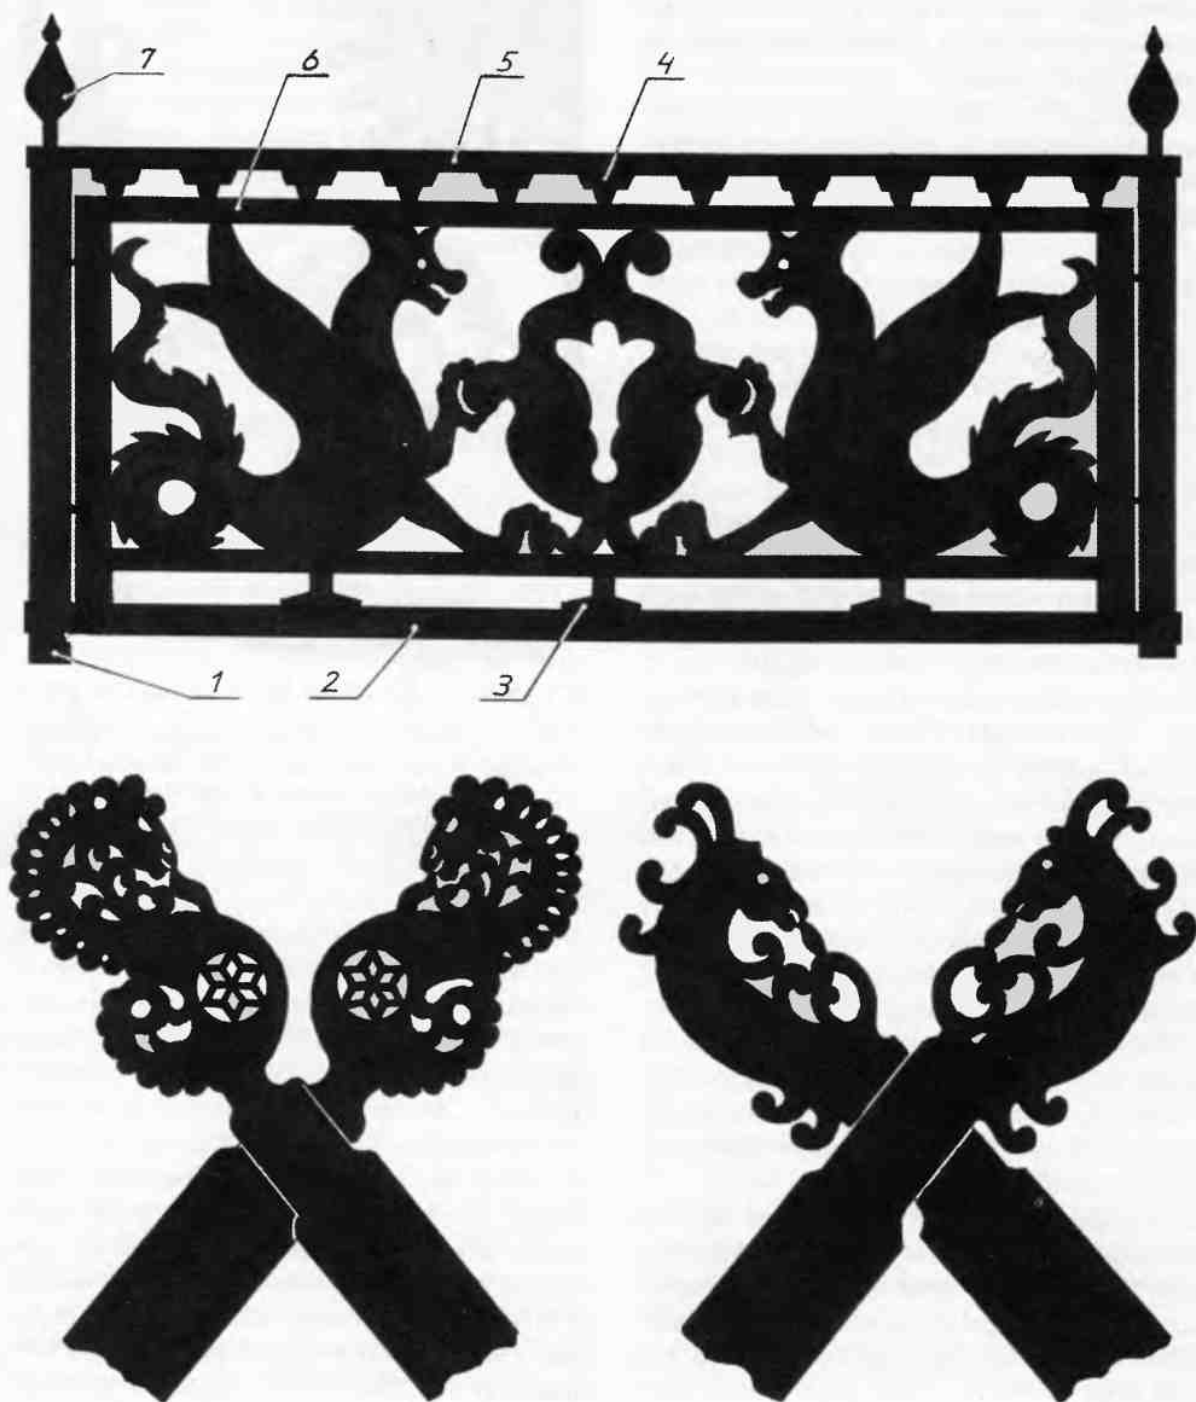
Дополнительные детали для декора крыши. Сверху — секция гребня крыши или декоративной ограды по краю крыши: 1 — стойка; 2 — боковые соединительные накладки; 3 — нижние распорки (крепятся между боковыми накладками); 4 — верхние распорки (прибиваются к верхней соединительной накладке 5); 5 — соединительная накладка; 6 — резная панель; 7 — фнала (крепится шипом в накладке 5). Снизу — коньки и косули, вырезанные на комлевых (широких) концах причельных досок (старосаксонская резьба)
